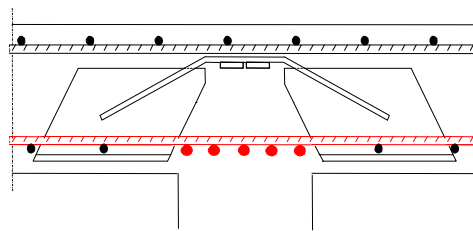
Bewehrungsführung bei Innenstützen (Einsturzsicherung)
